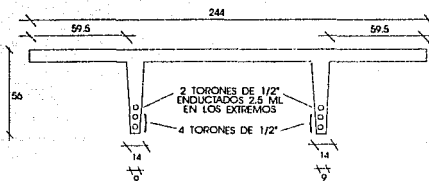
SECCION DE PREFUERZO DE LAS "DOBLES T"
